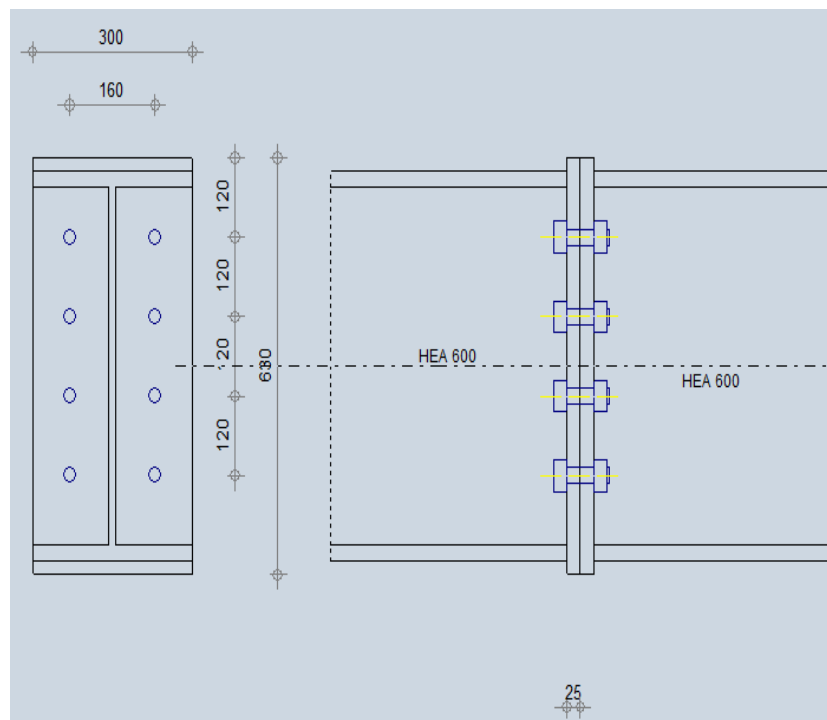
disposition des boulons de l'Assemblage Poteau- Poteau (HEA600-HEA600)
